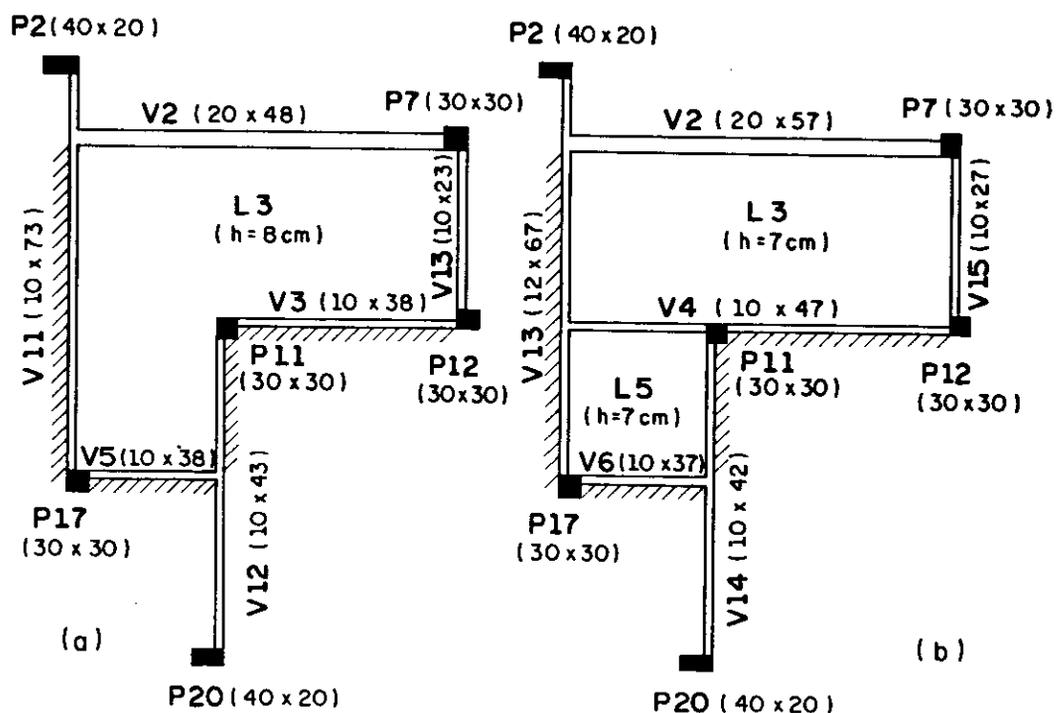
Painéis para o Estudo da Viabilidade da Divisão das Lajes L3 da ESTRUTURA I
